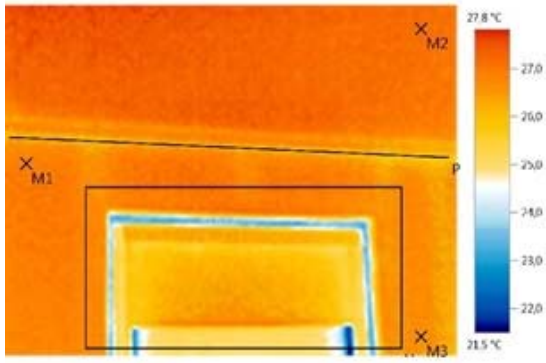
Тепловизионное исследование. Фрагмент 1
